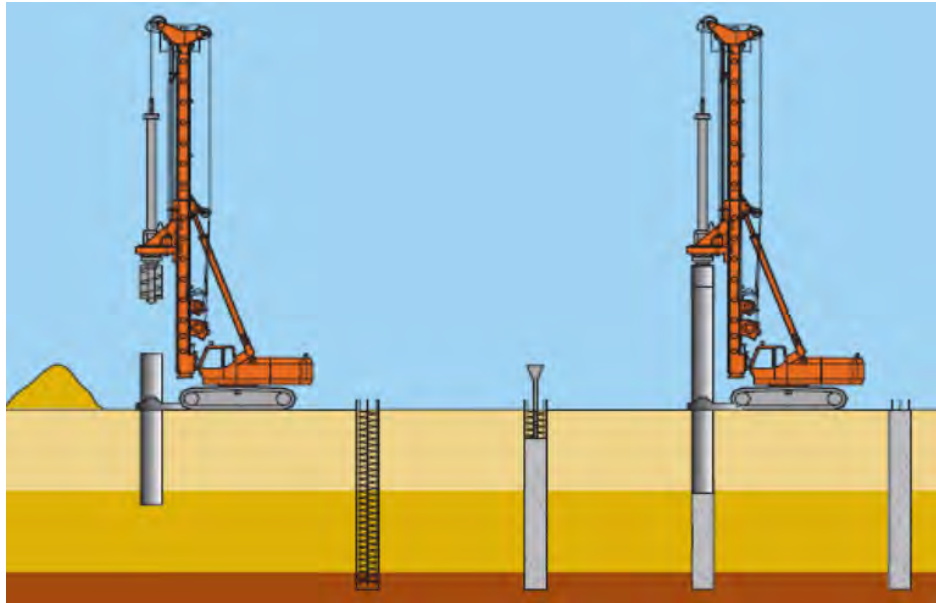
Proceso constructivo con camisa metálica. (Fuente: Pilotes Terratest. 2001)
